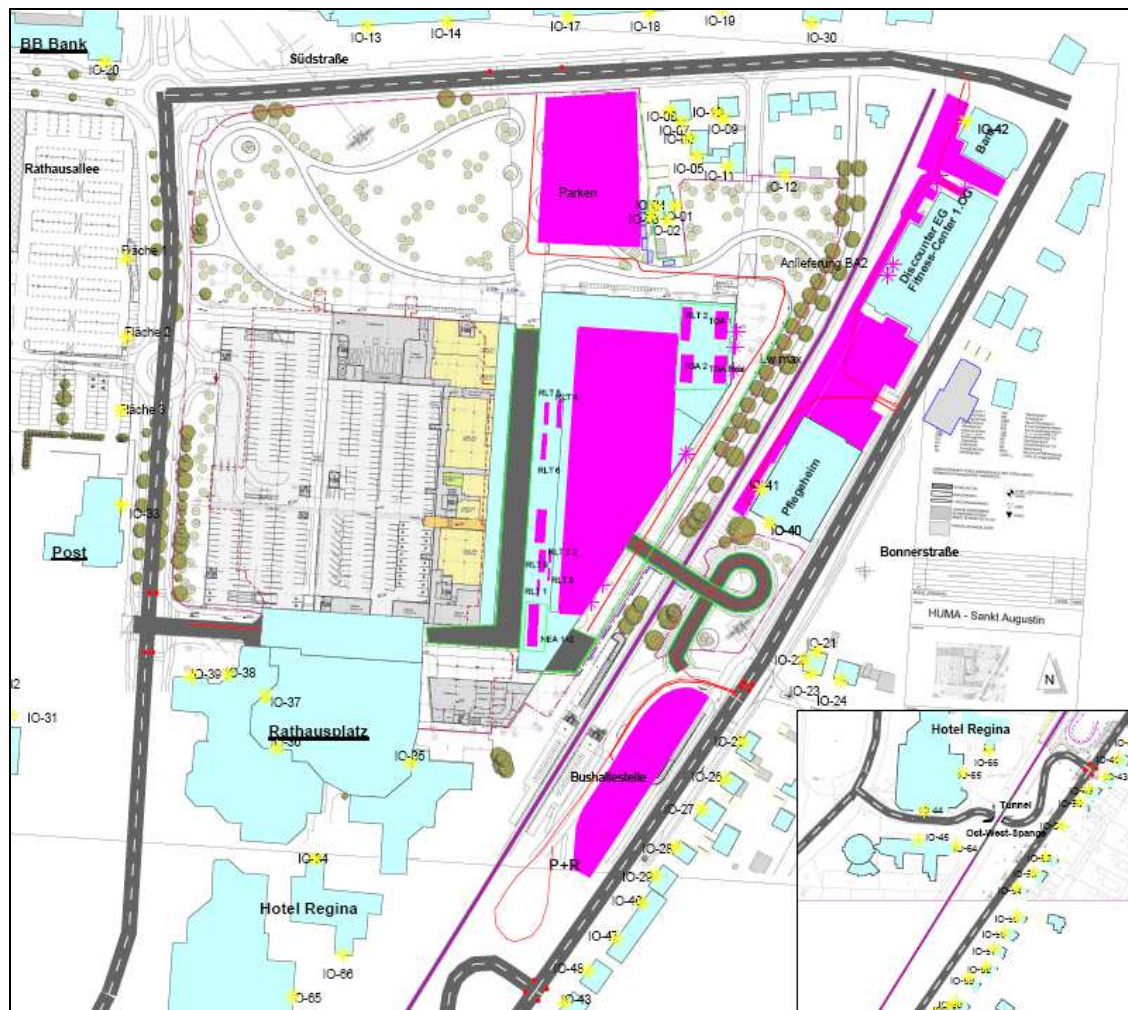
Lageplan Bauphase 2 (Anlage 1.3)
